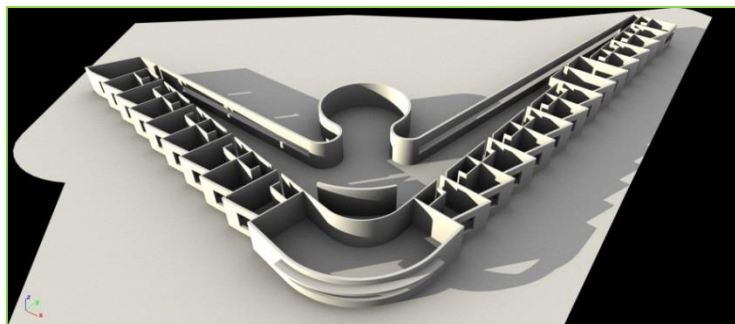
Esboço 1 do Projeto de Arquitetura
